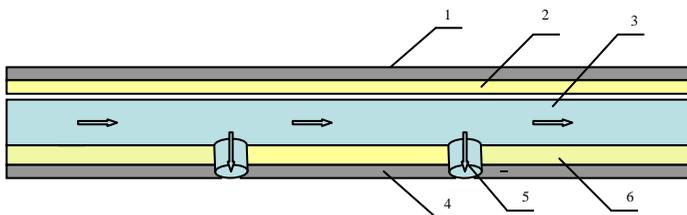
Предлагаемая плита перекрытия со встроенной системой вентиляции: 1, 4 – керамзитобетон толщиной 60 мм; 2, 6 – базальтовый утеплитель толщиной 50 мм; 3 – воздуховод; 5 – воздухораспределитель
